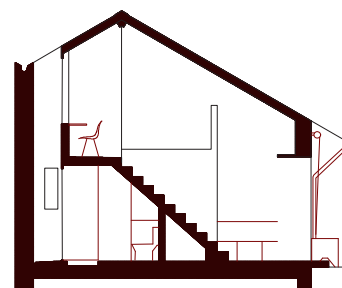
Secção tipo A Ilha da Bela Vista - LAHBSocial
